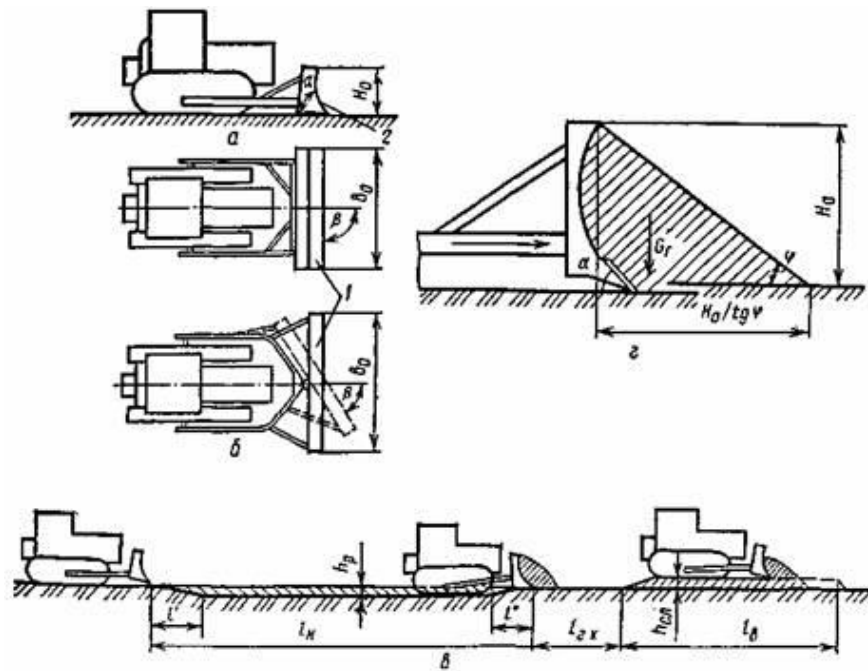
Основные схемы укладки грунта бульдозерами
